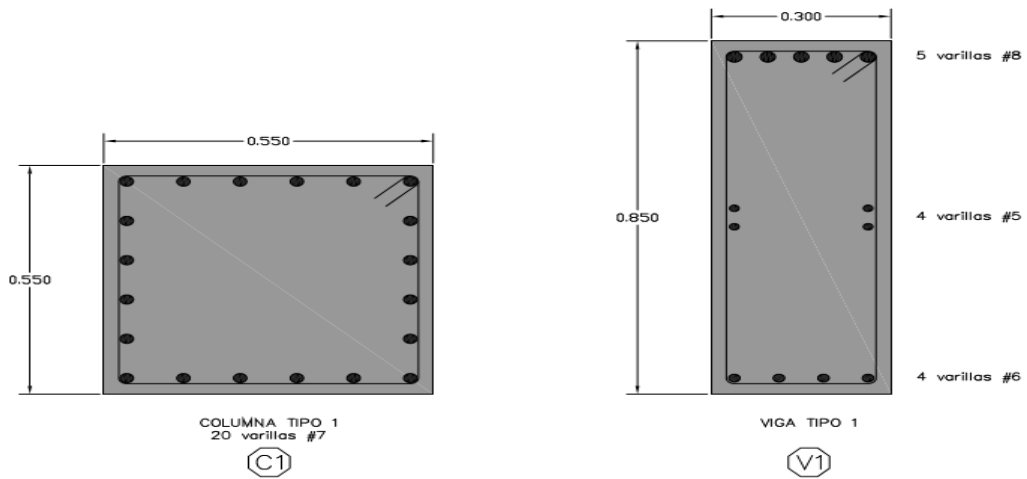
Detalles constructivos para el edificio de 4 niveles
